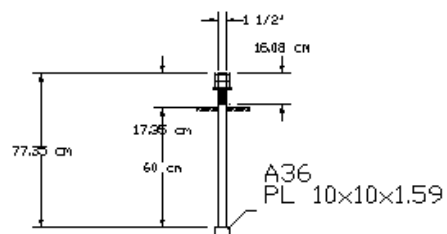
Detalle constructivo de anclajes AN-1. (Fuente: Propia).
